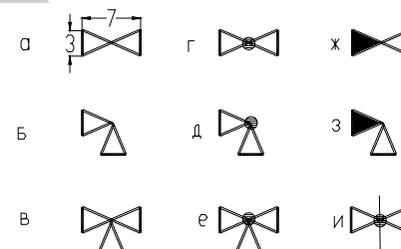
Изображение трубопроводной арматуры: а – проходной вентиль; б – угловой вентиль; в – трехходовой вентиль; г – проходной кран; д – угловой кран; е – трехходовой кран; жс – проходной клапан; з – угловой клапан; и – задвижка
